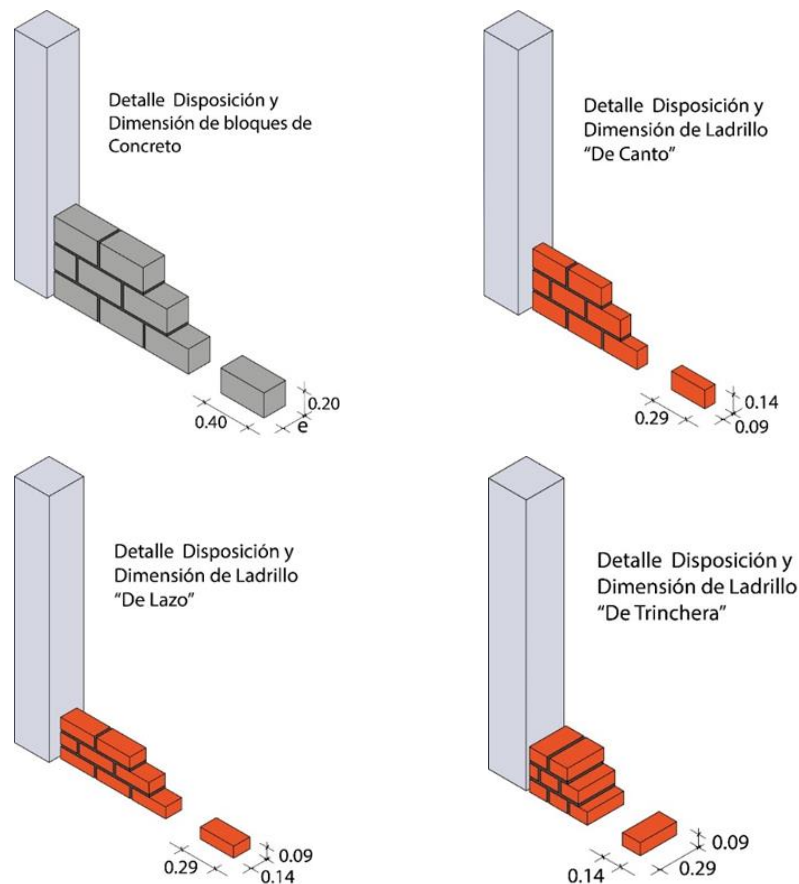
Detalle disposición y dimensiones de tipo de mampuestos
